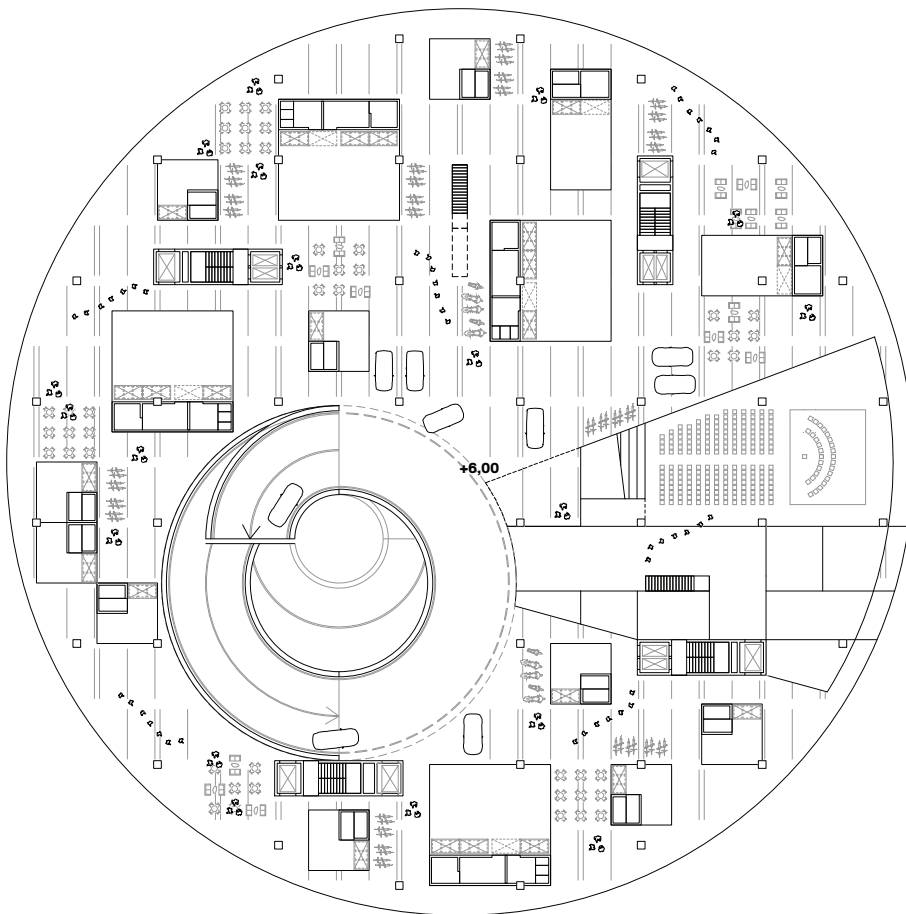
Grundriss . Logistikgeschoss (-06) . 1:750
